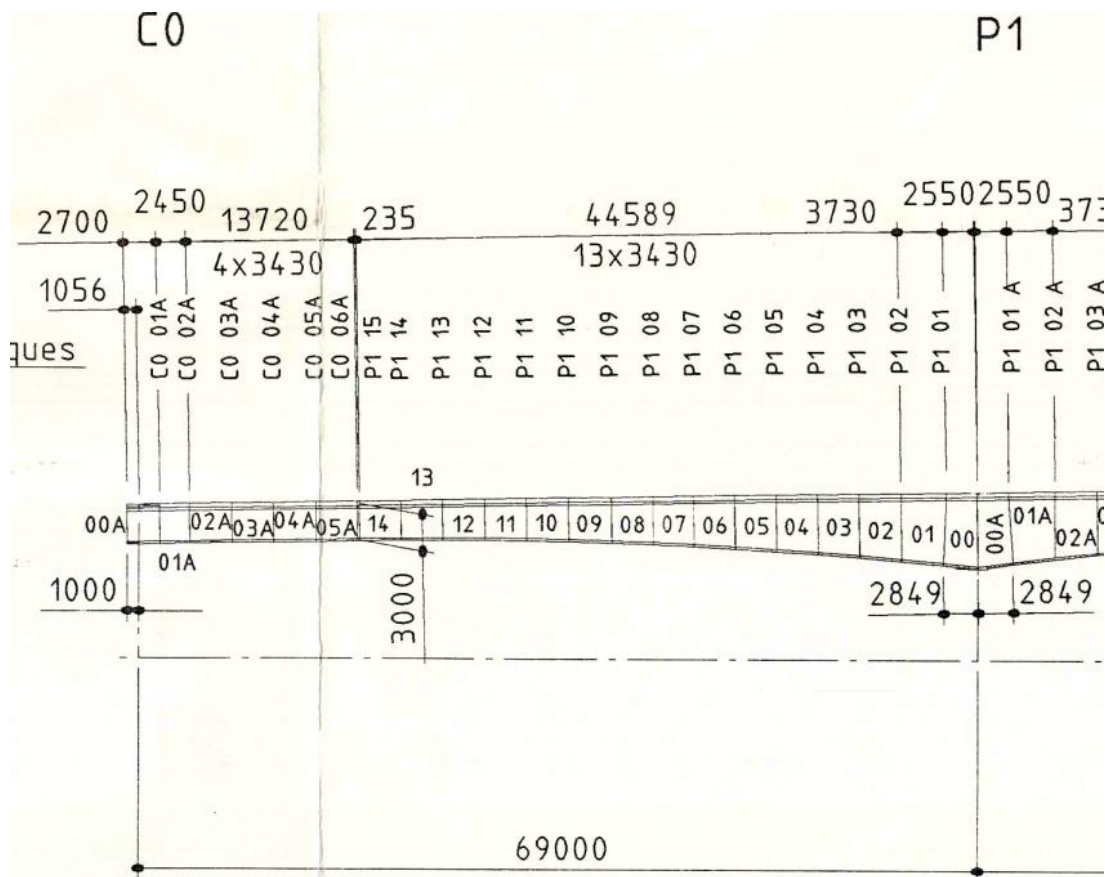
Vue longitudinale de la travée de rive T1 (extrait plan P402)
